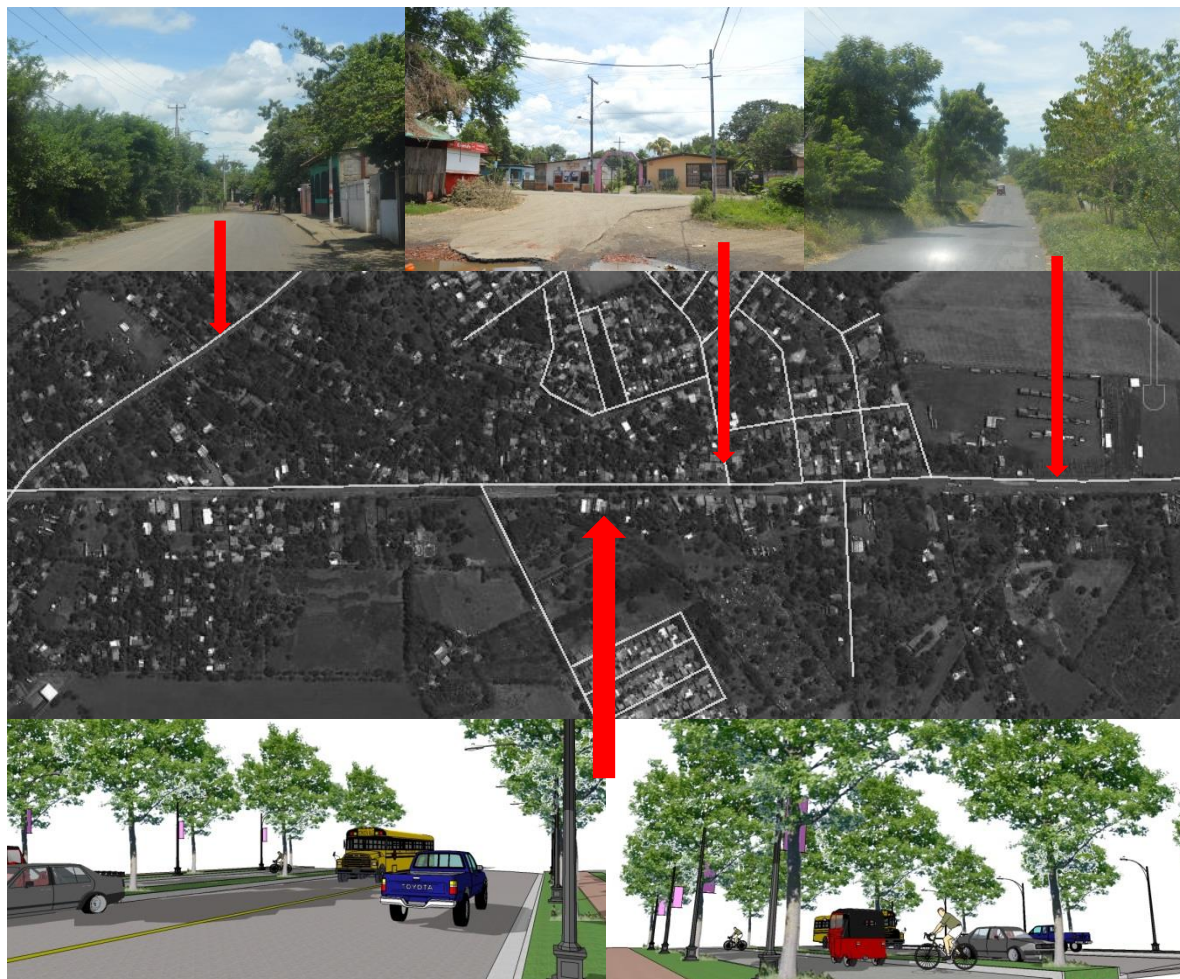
Propuestas de mejoras viales, estado actual y estado proyectado. Elaboración: propia.
